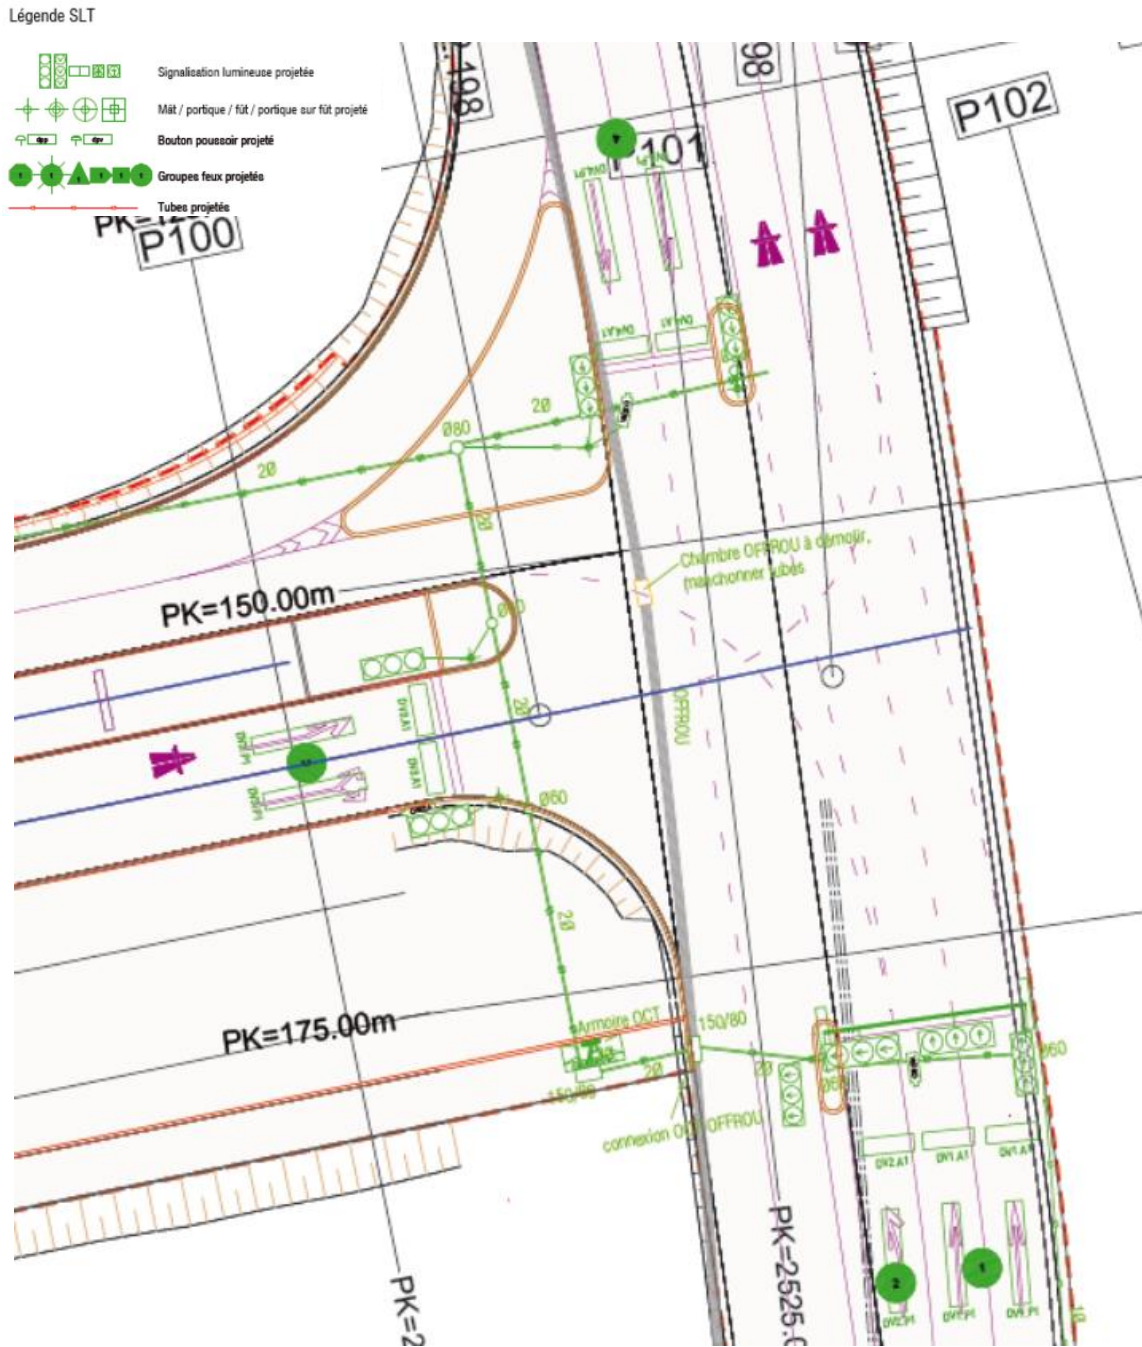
Plan de SLT Bretelle autoroutière - Abarois
